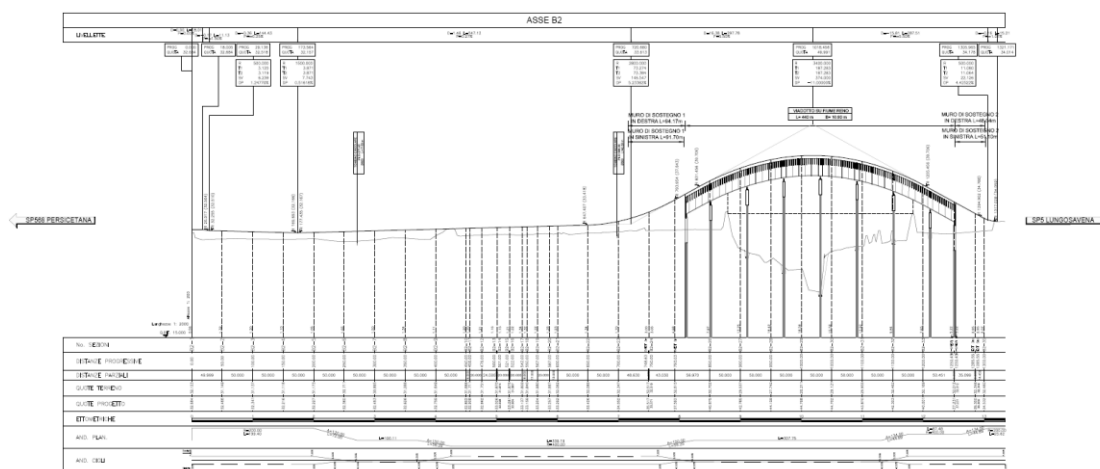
estratto dal progetto riguardante l'andamento planimetrico dell'Asse B2
